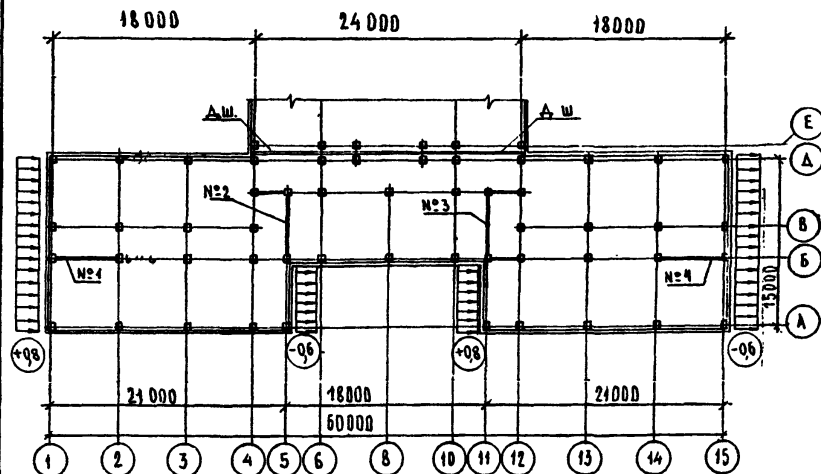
Схема приложения горизонтальной (ветровой) нагрузки вдоль буквенных осей здания (вариант 1).
